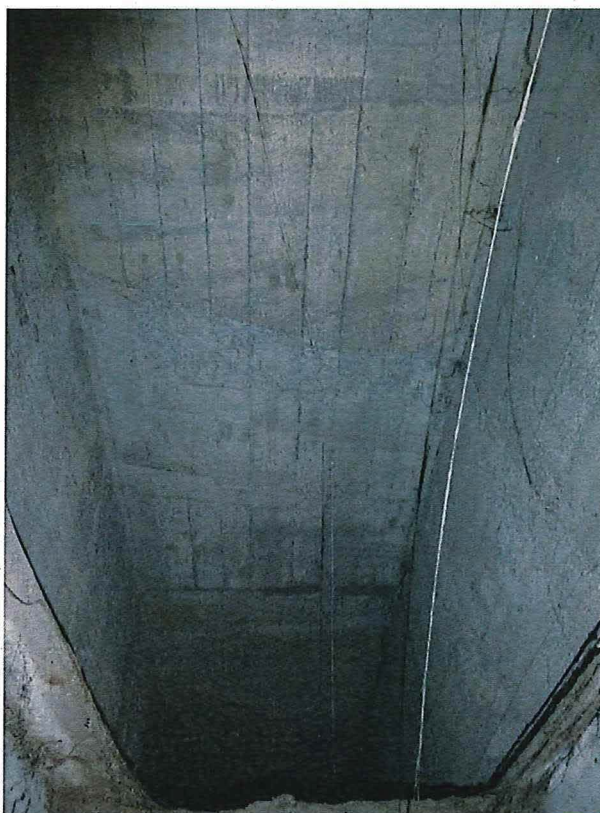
Zicht in de schacht tussen beide verdiepingen.
